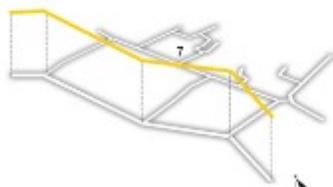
Planta Etapa 4-Calle tipo 7.
